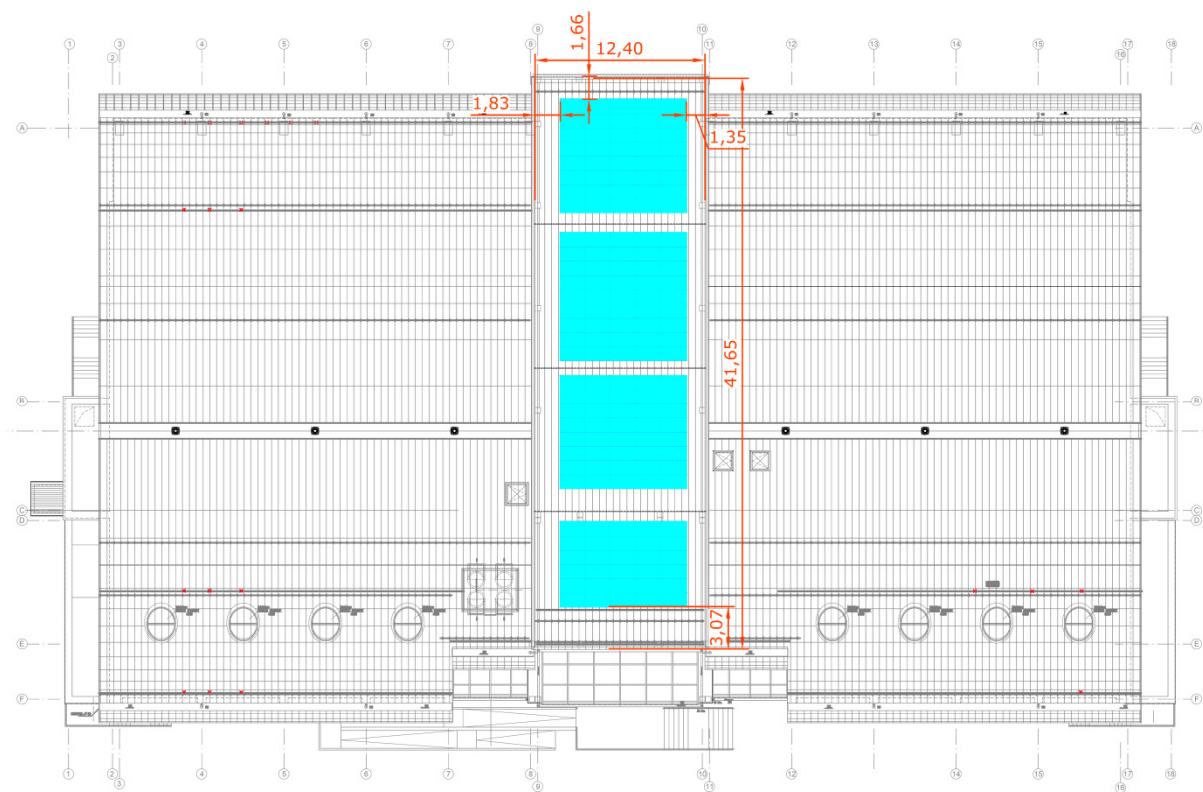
Rzut konstrukcji dachu wraz z przekrojem [2].
